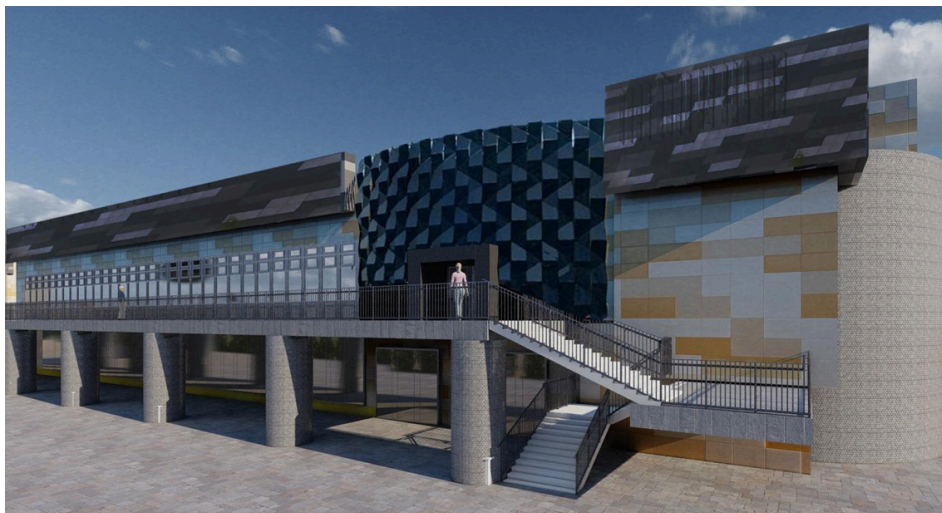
Торговий центр Південний Буг .Головний фасад будівлі.
